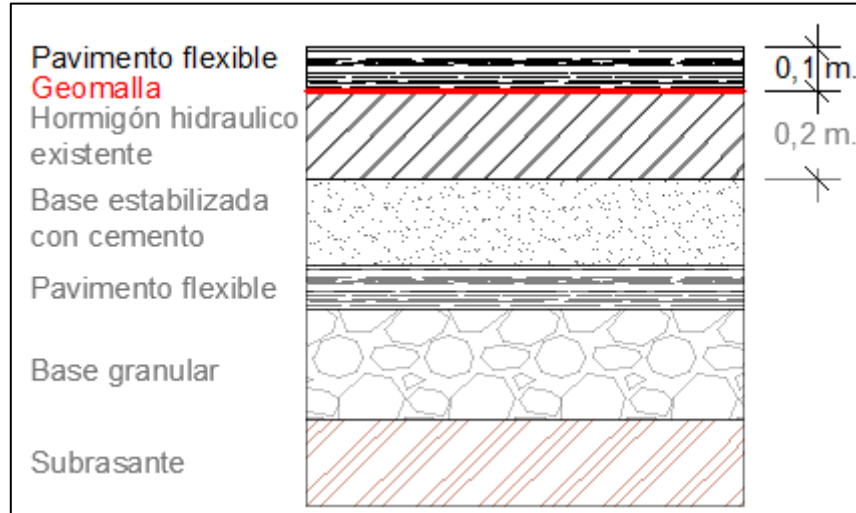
Capa de pavimento flexible sobre estructura existente
